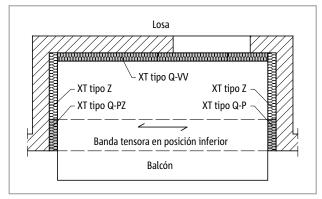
Schöck Isokorb® XT tipo Q-VV, Q-P, Q-PZ: Logia con apoyo en tres lados y banda tensora
